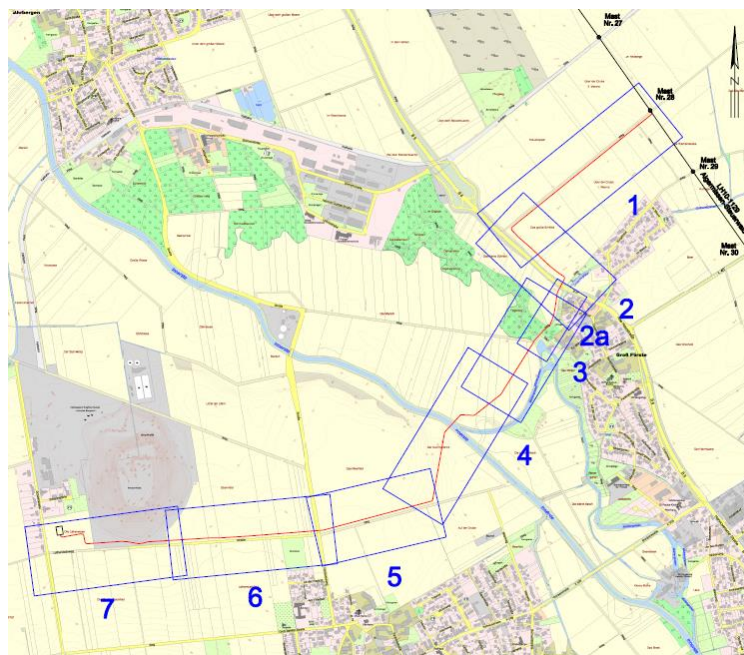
Lageplan 110 kV-Trassenverlauf Südvariante
